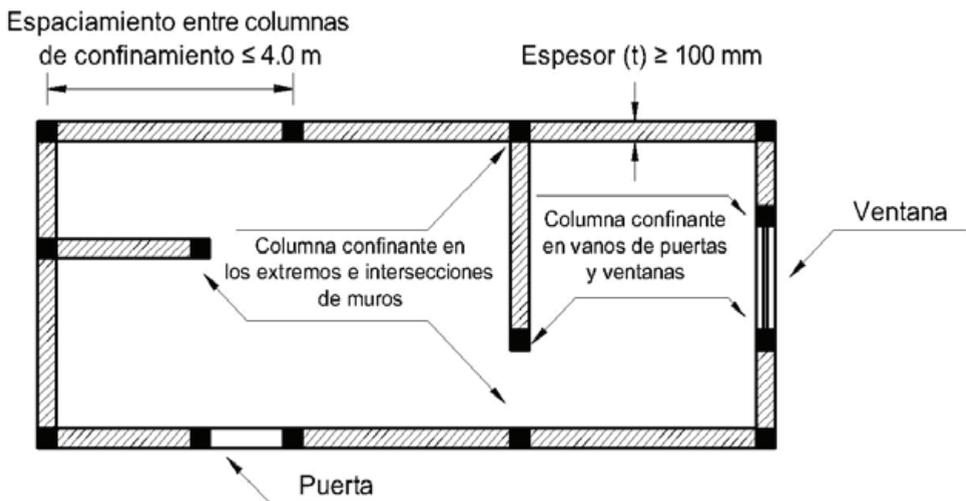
Requisitos fundamentales en viviendas de mampostería confinada
